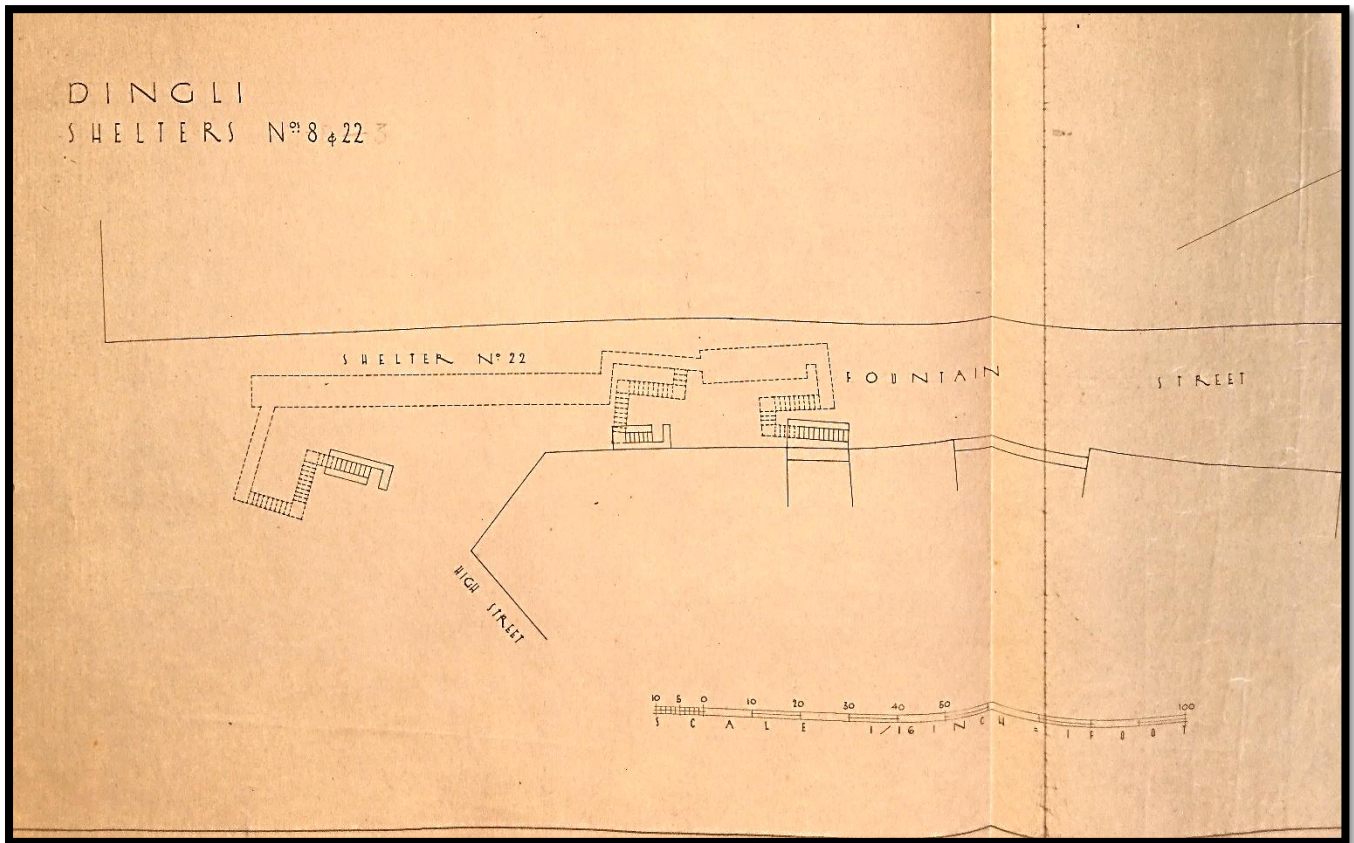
Planta do Abrigo nº 8 e 22 (3) "Rouniain Street."
